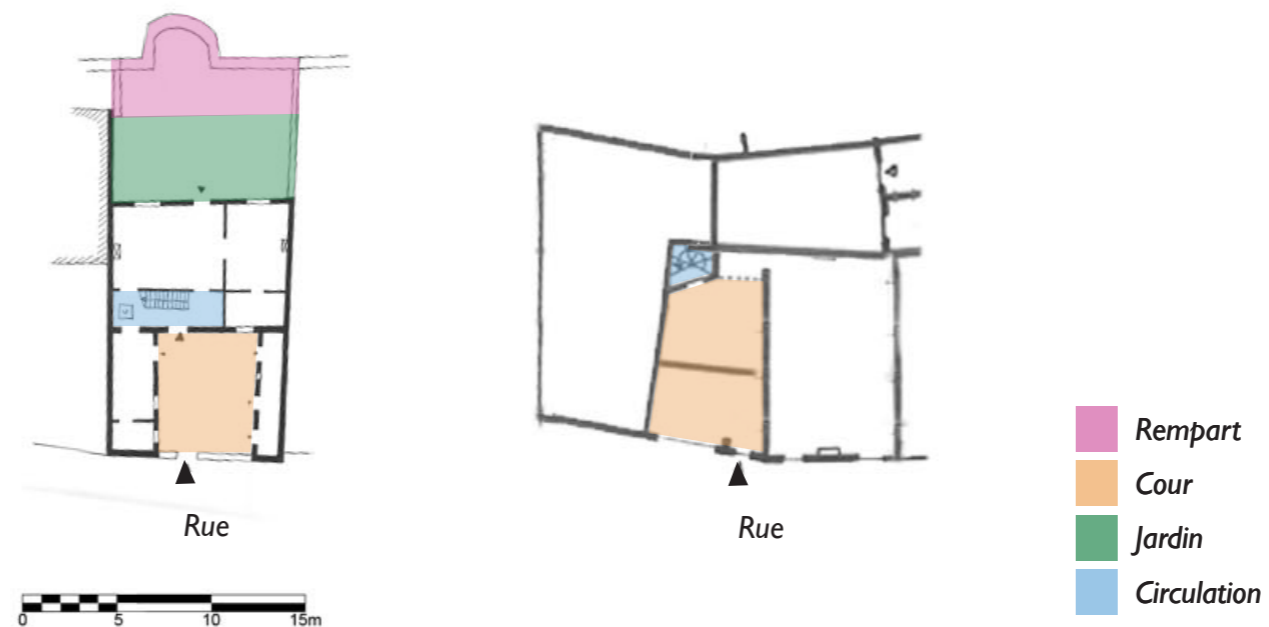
Plans rez-de-chaussée des hôtels particuliers avec cour d'entrée
